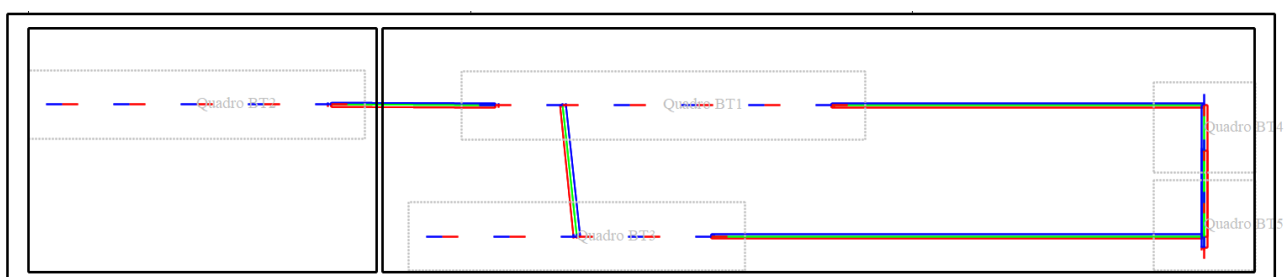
Layout dei locali QGBT piano primo – vista in pianta
